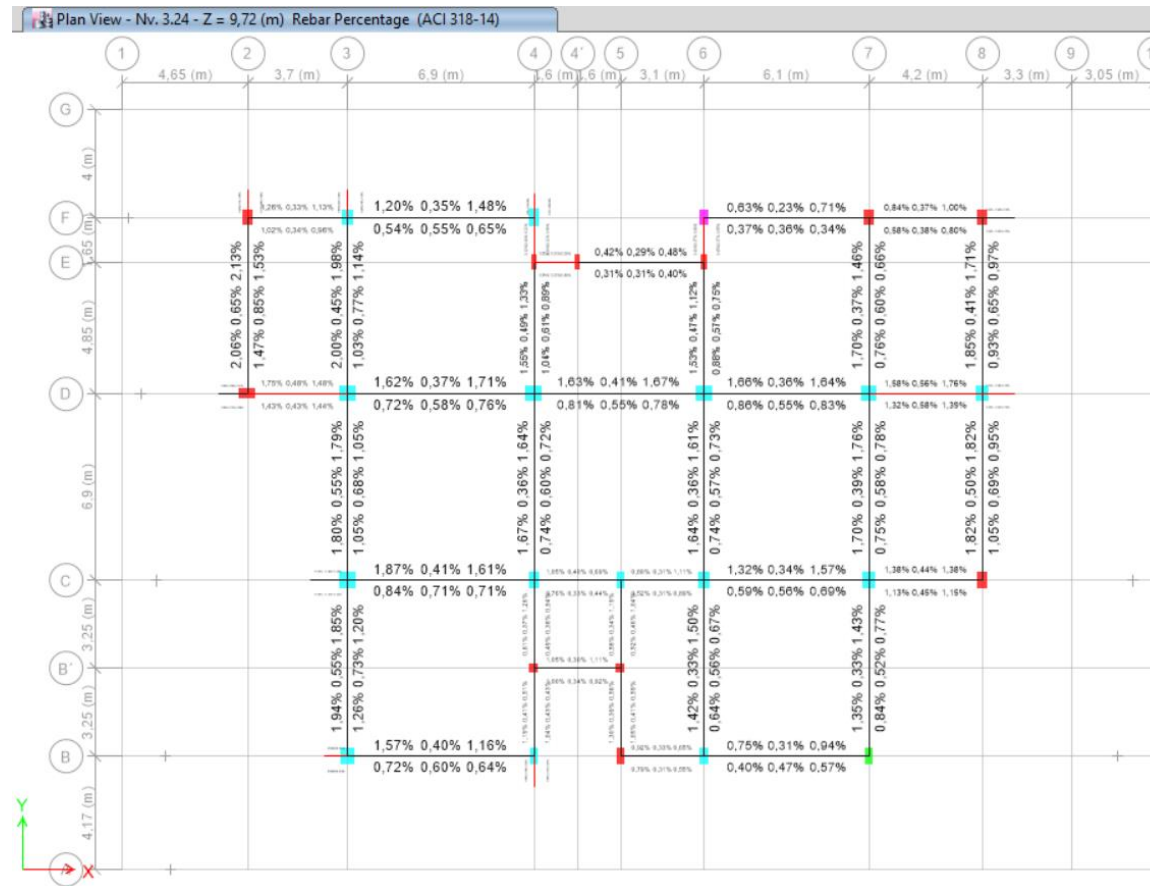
Vista en planta del porcentaje en acero en vigas, nivel 0,00 m.
